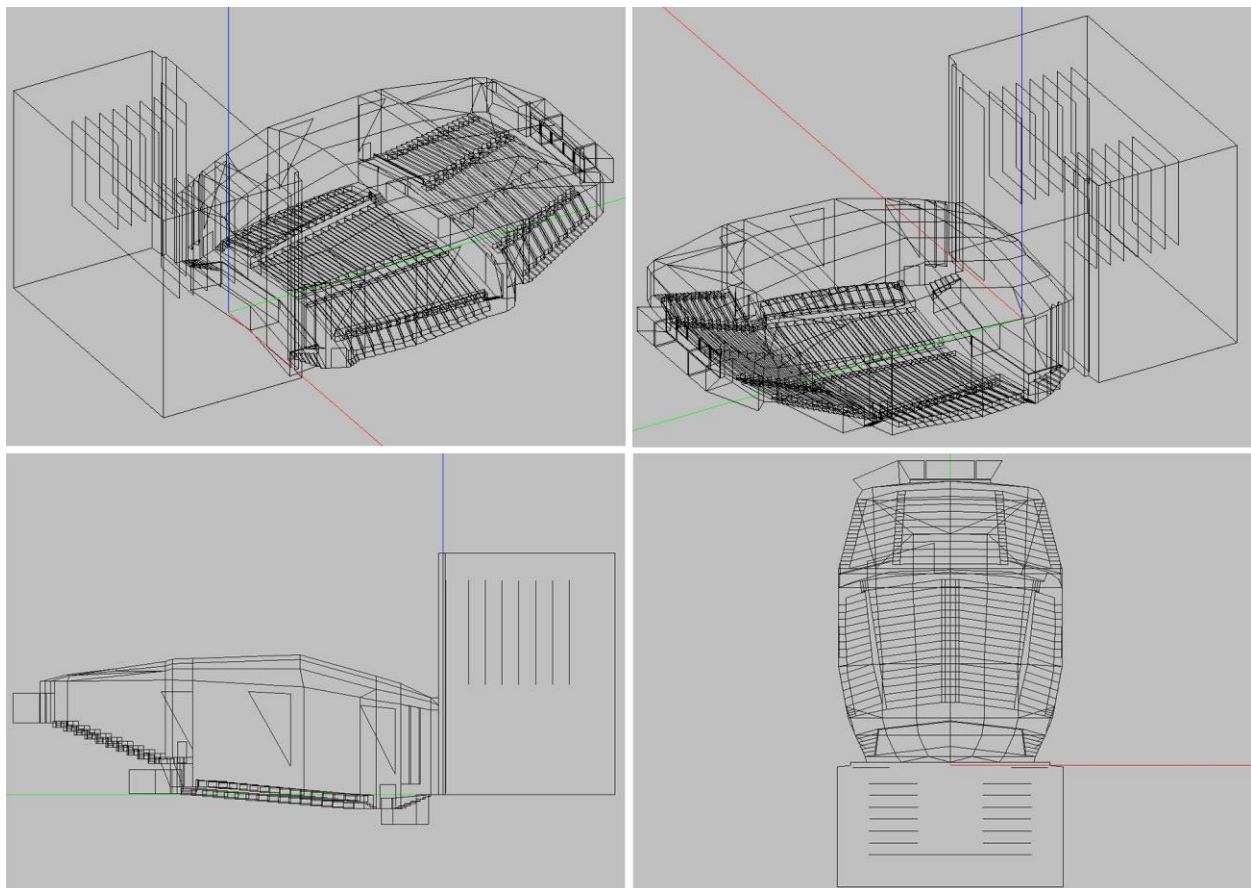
Vista del modelo 3D en Room Editor: perspectiva (arriba), sección (abajo izq.) y planta (abajo drcha.)
